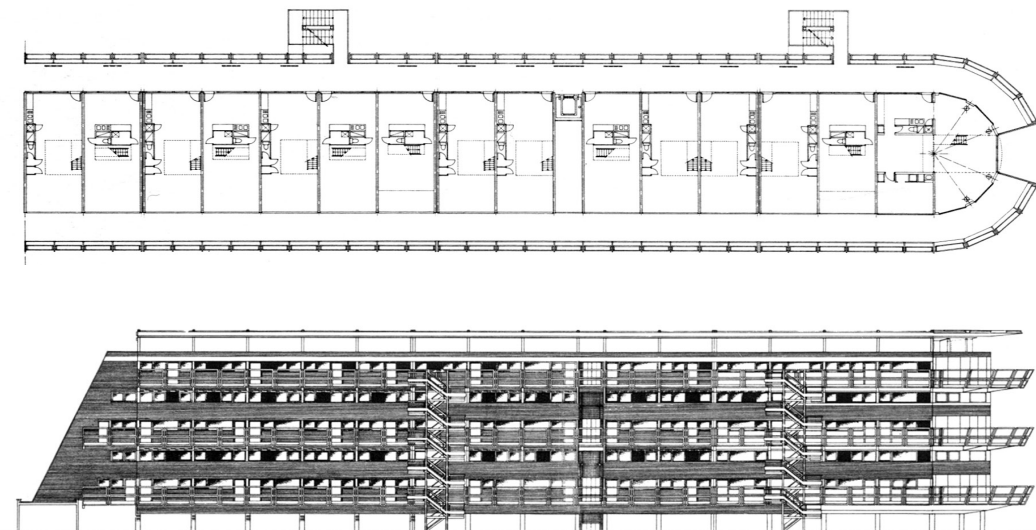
Planta e alçado de um dos volumes do *NEMAUSUS*.
